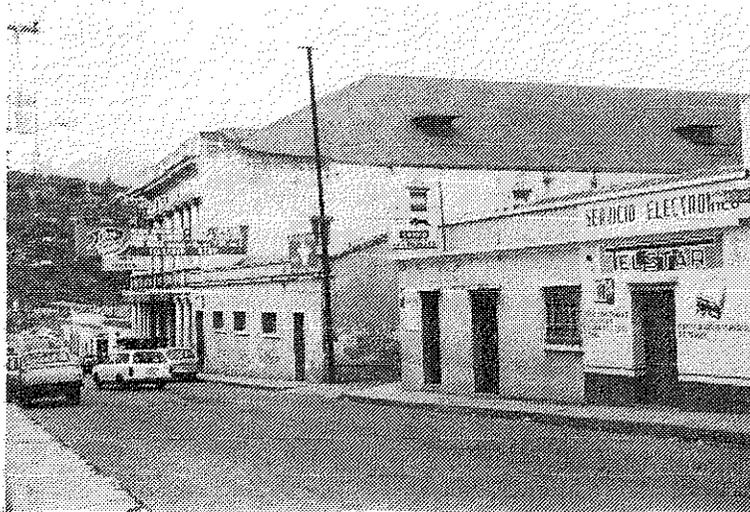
Deterioro físico y conceptual, en el colorido de la fachada, rótulos, caja telefónica expuesta, postes de luz, banqueta de piedra teja en mal estado de conservación. (en esta casa vivió el Maestro Carlos Mérida). (fuente: autor).
